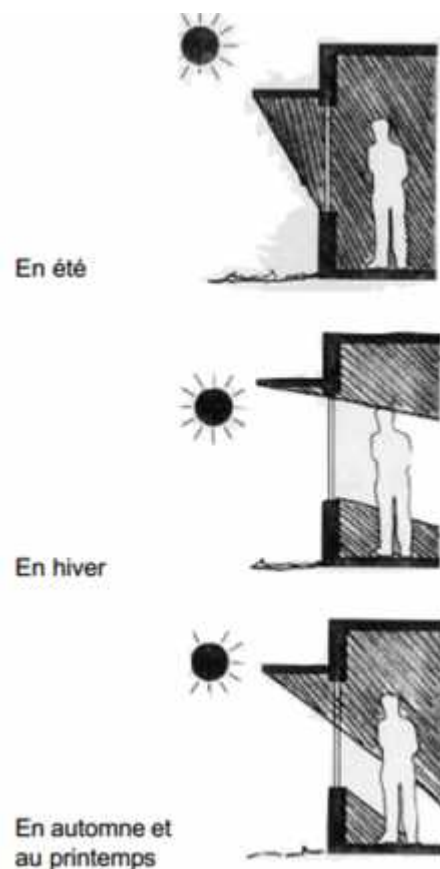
protection solaire suivant la saison (source architecture et climat wallonne -dgtre, 1997)
